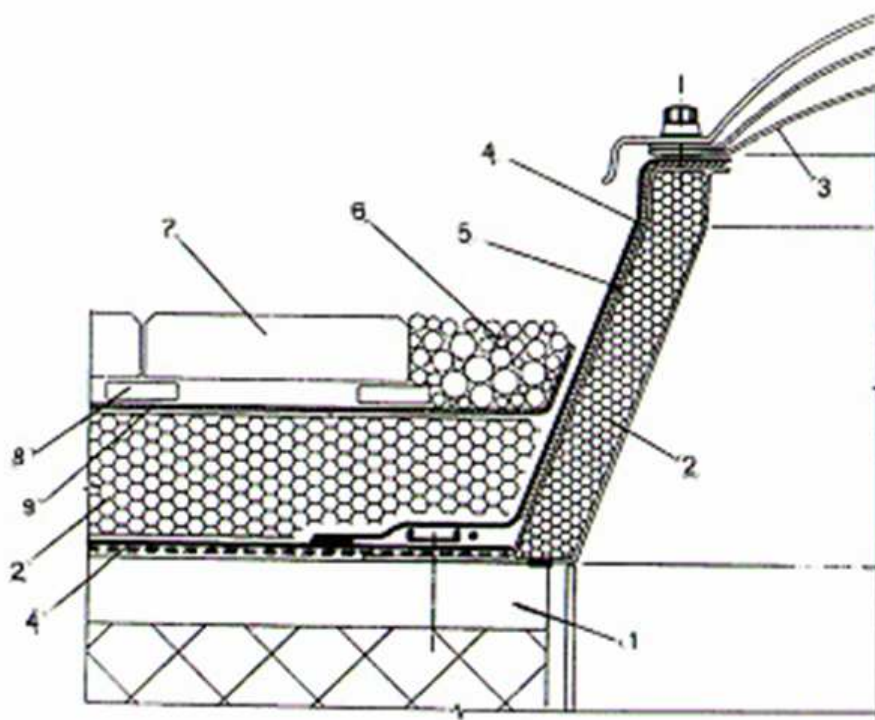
Соединение инверсионной эксплуатируемой кровли с фонарём:
